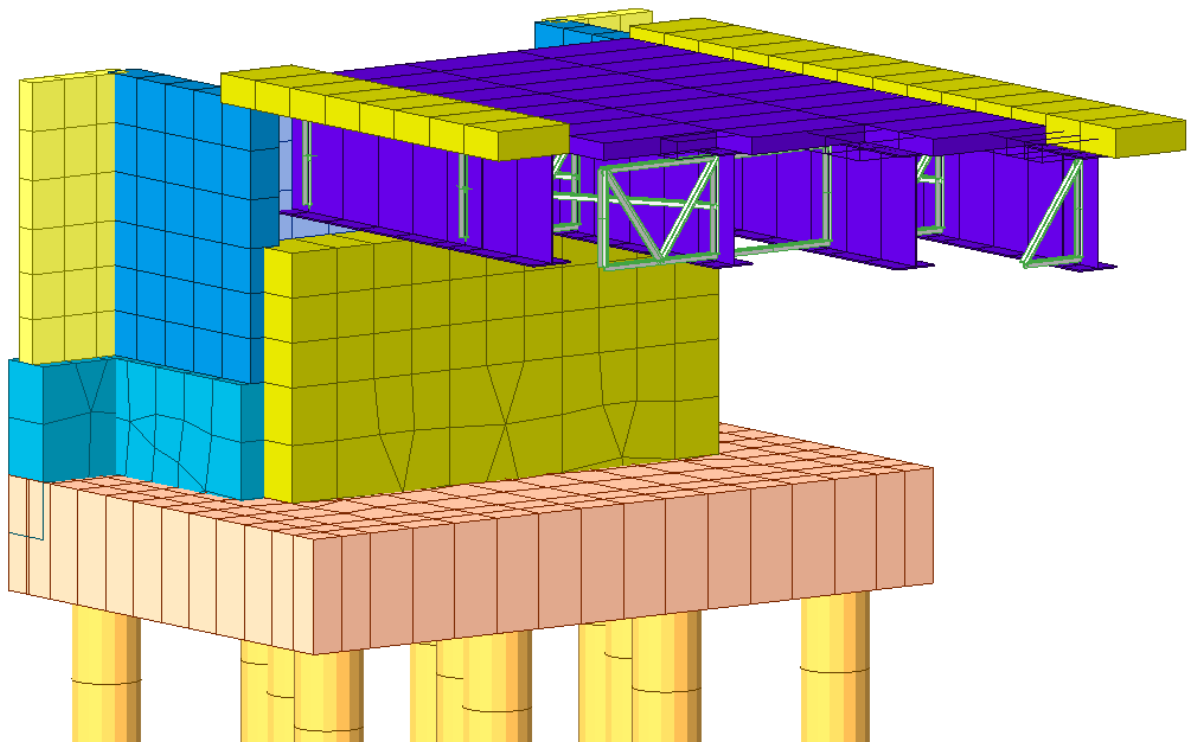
Modellazione tridimensionale Elementi finiti – spalla
